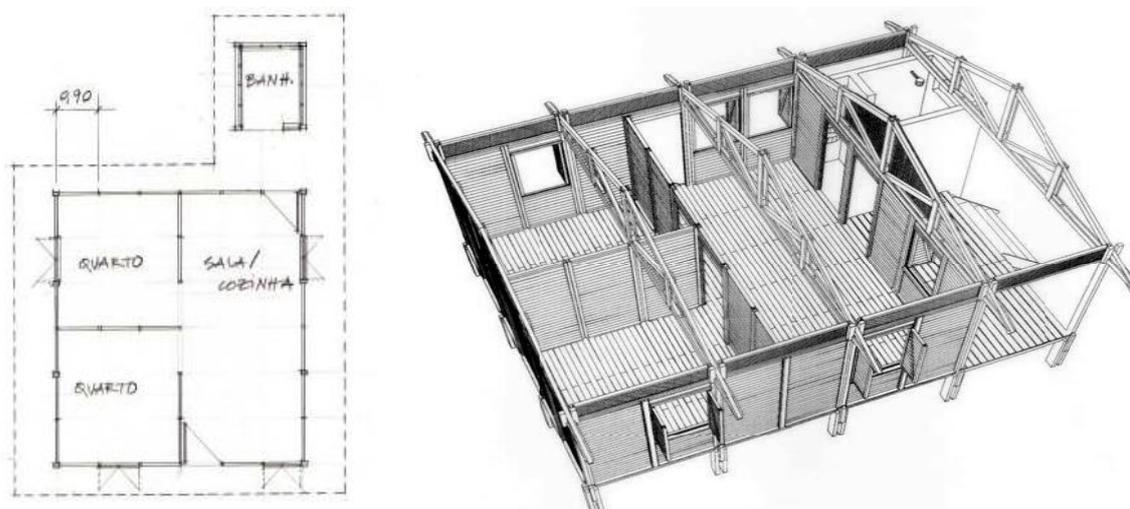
Perspectiva do projeto original / planta da casa construída, Pedra 90.
